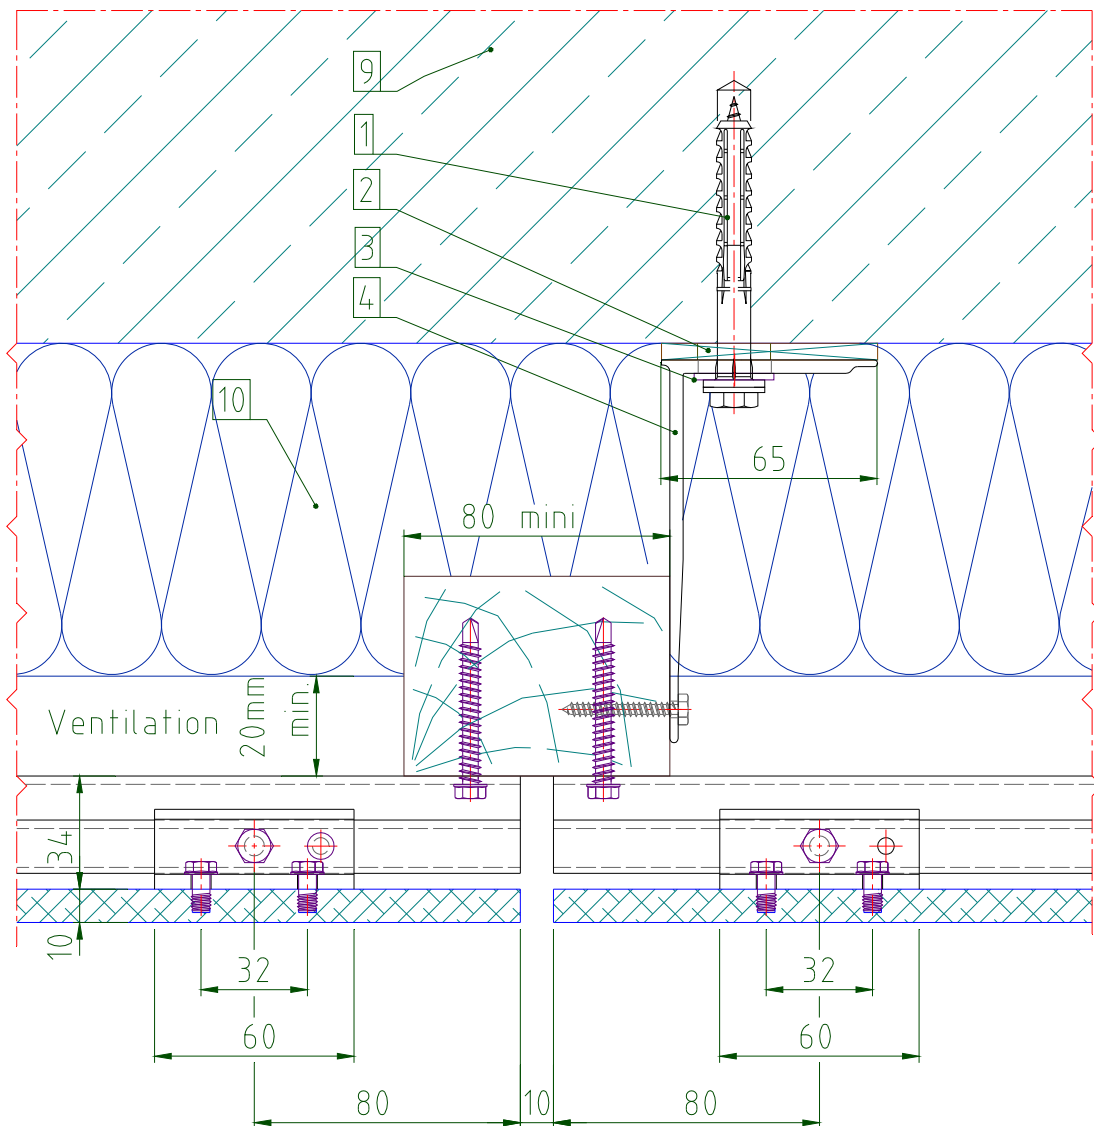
Détail aboutage rails horizontaux – Ossature bois
